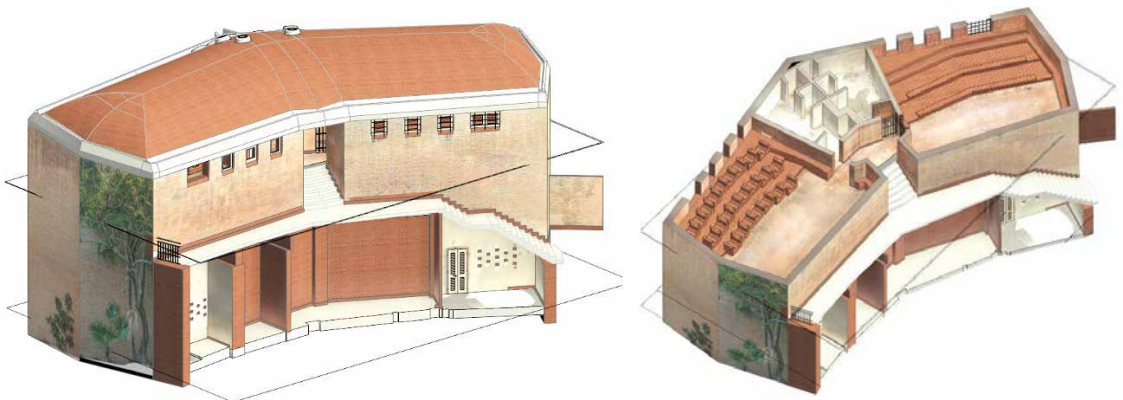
| Vista 3D de los muros exteriores del bloque 5 con inserción de los fotorplanos correspondientes y sección horizontal 3D con inserción de los fotorplanos de pavimentos y muros interiores. | Vista 3D delle pareti esterno del blocco 5 con inserimento dei relativi fotorpiani e sezione orizzontale 3D con inserimento dei fotorpiani relativi a pavimenti a pareti interne.
